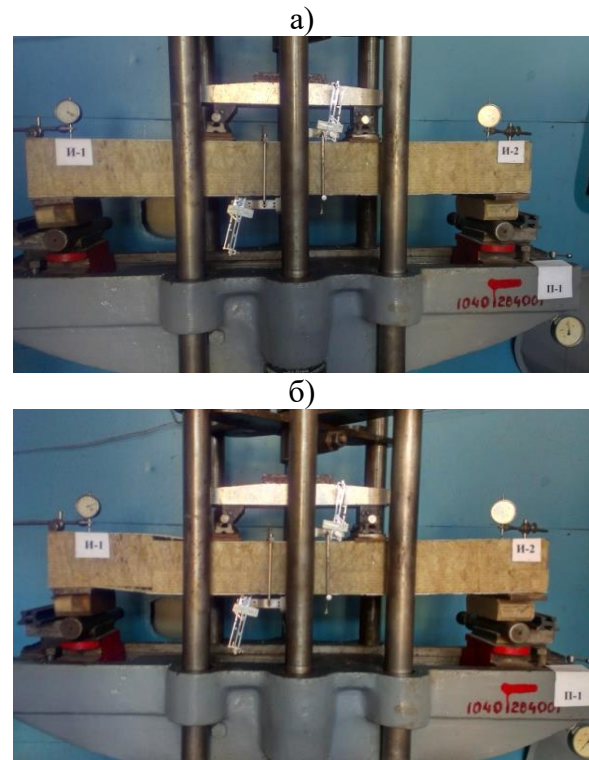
Образец с минераловатным наполнителем под нагрузкой:
